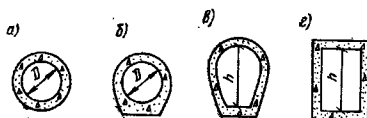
Основные формы поперечного сечения дренажных труб из бетона
